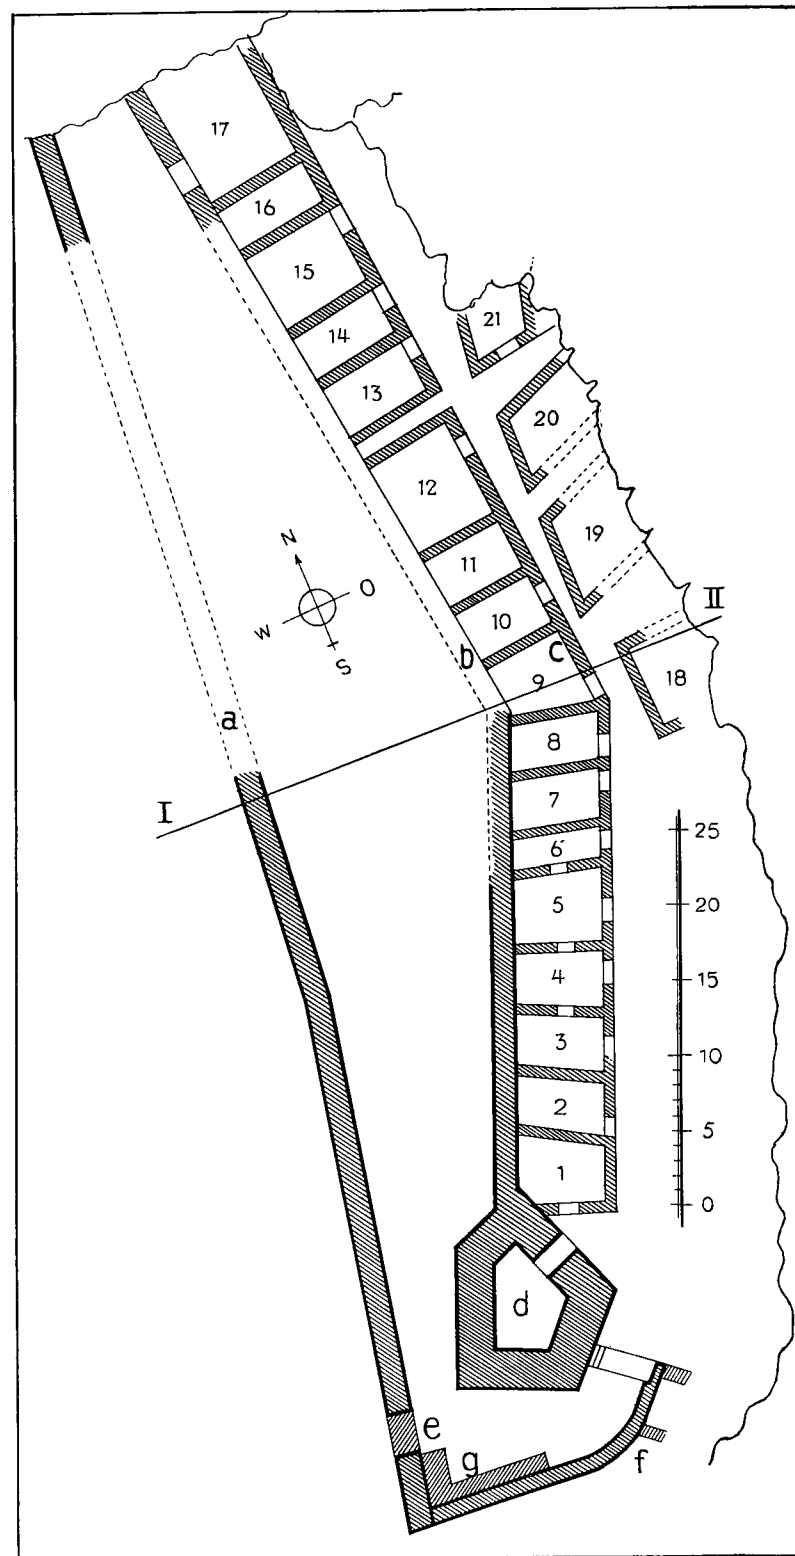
Lageplan der Festung Sadowetz. 1:500.
